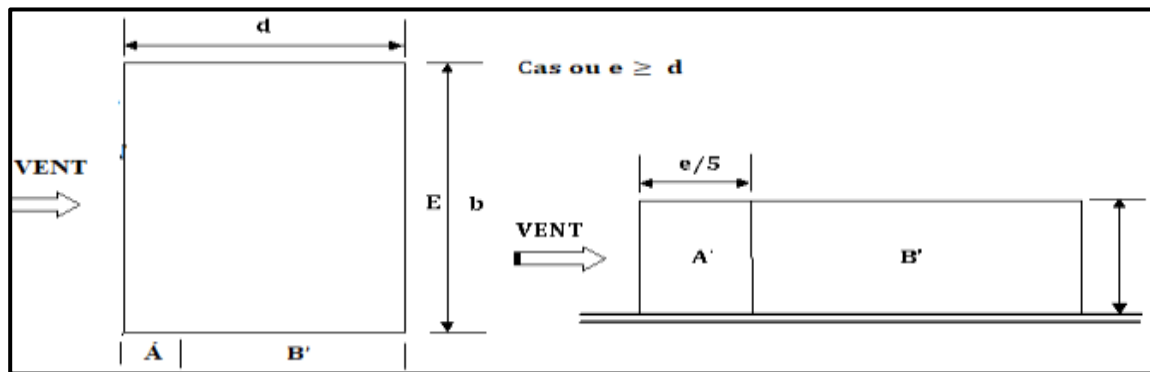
Vue en plan et vue en élévation, sens XZ.
